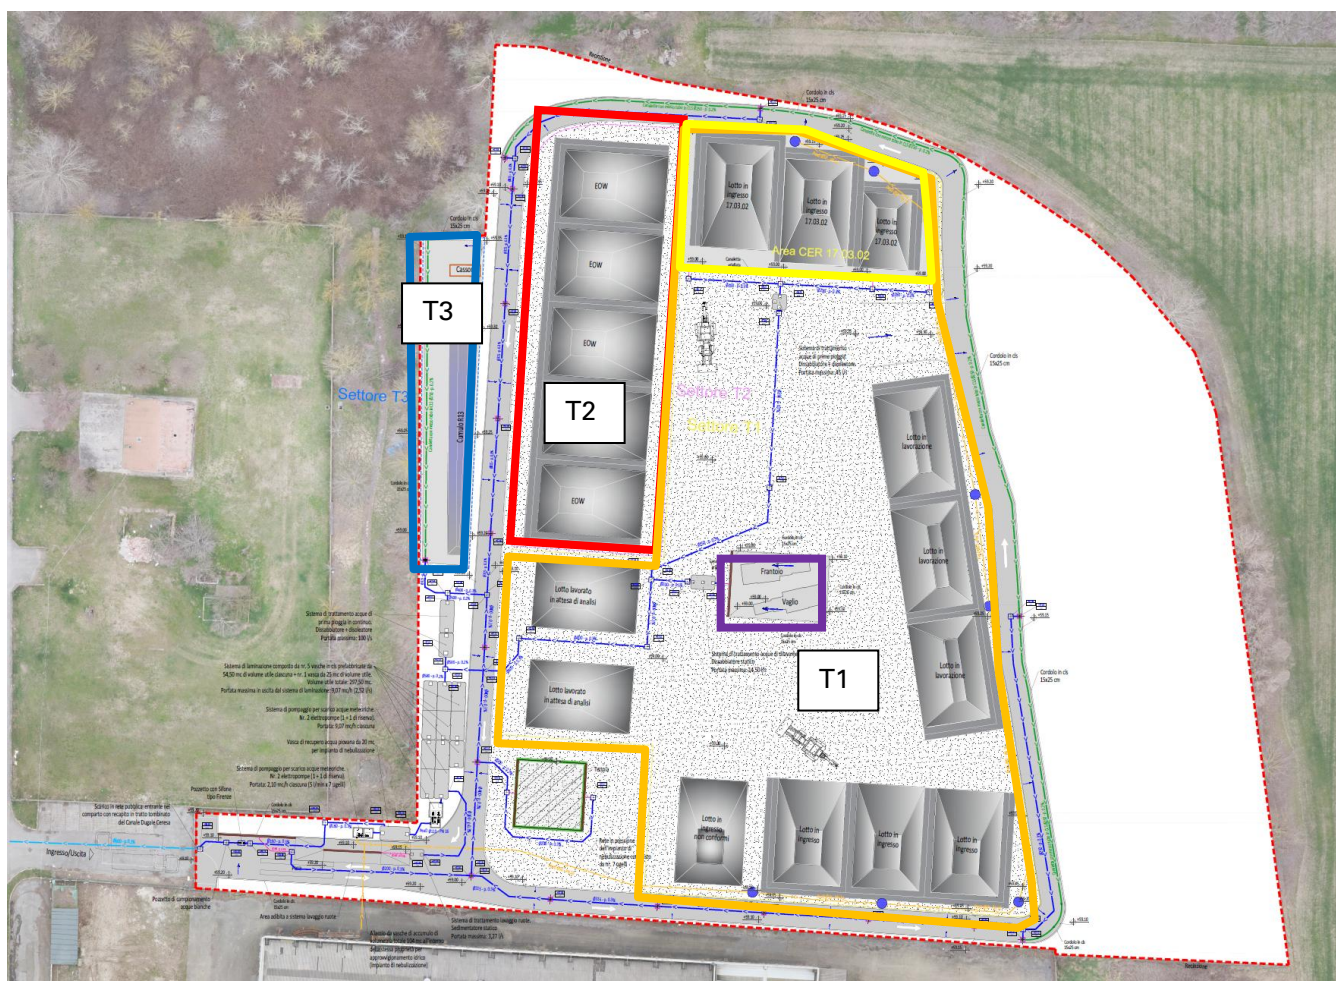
Planimetria stato di progetto – Suddivisione in settori
